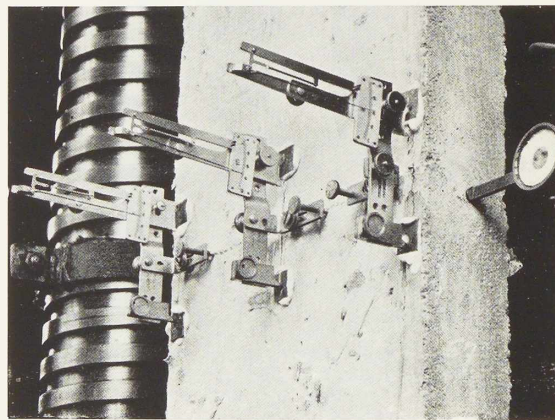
Poteau système « Alpha ». Mesure des tensions sur la dalle en béton.
